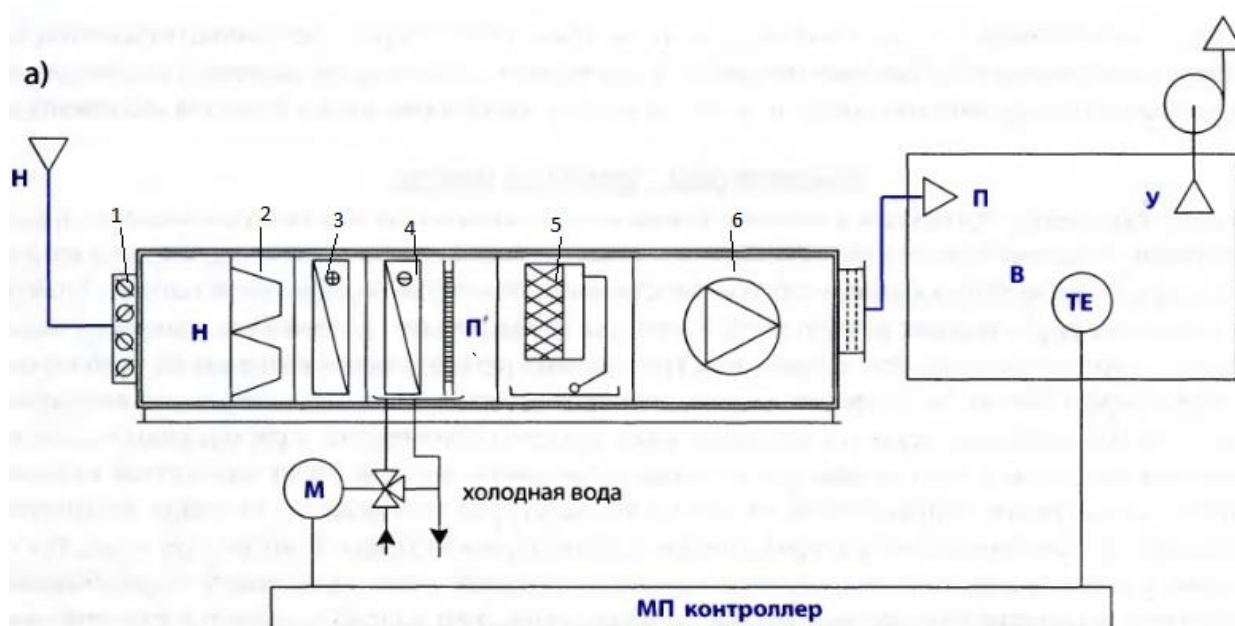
Прямоточная схема обработки воздуха с использованием второго подогрева (1-клапан;2-фильтр;3-воздухонагреватель; 4-воздухоохладитель; 5- камера орошения (увлажнитель); 6- вентилятор)
